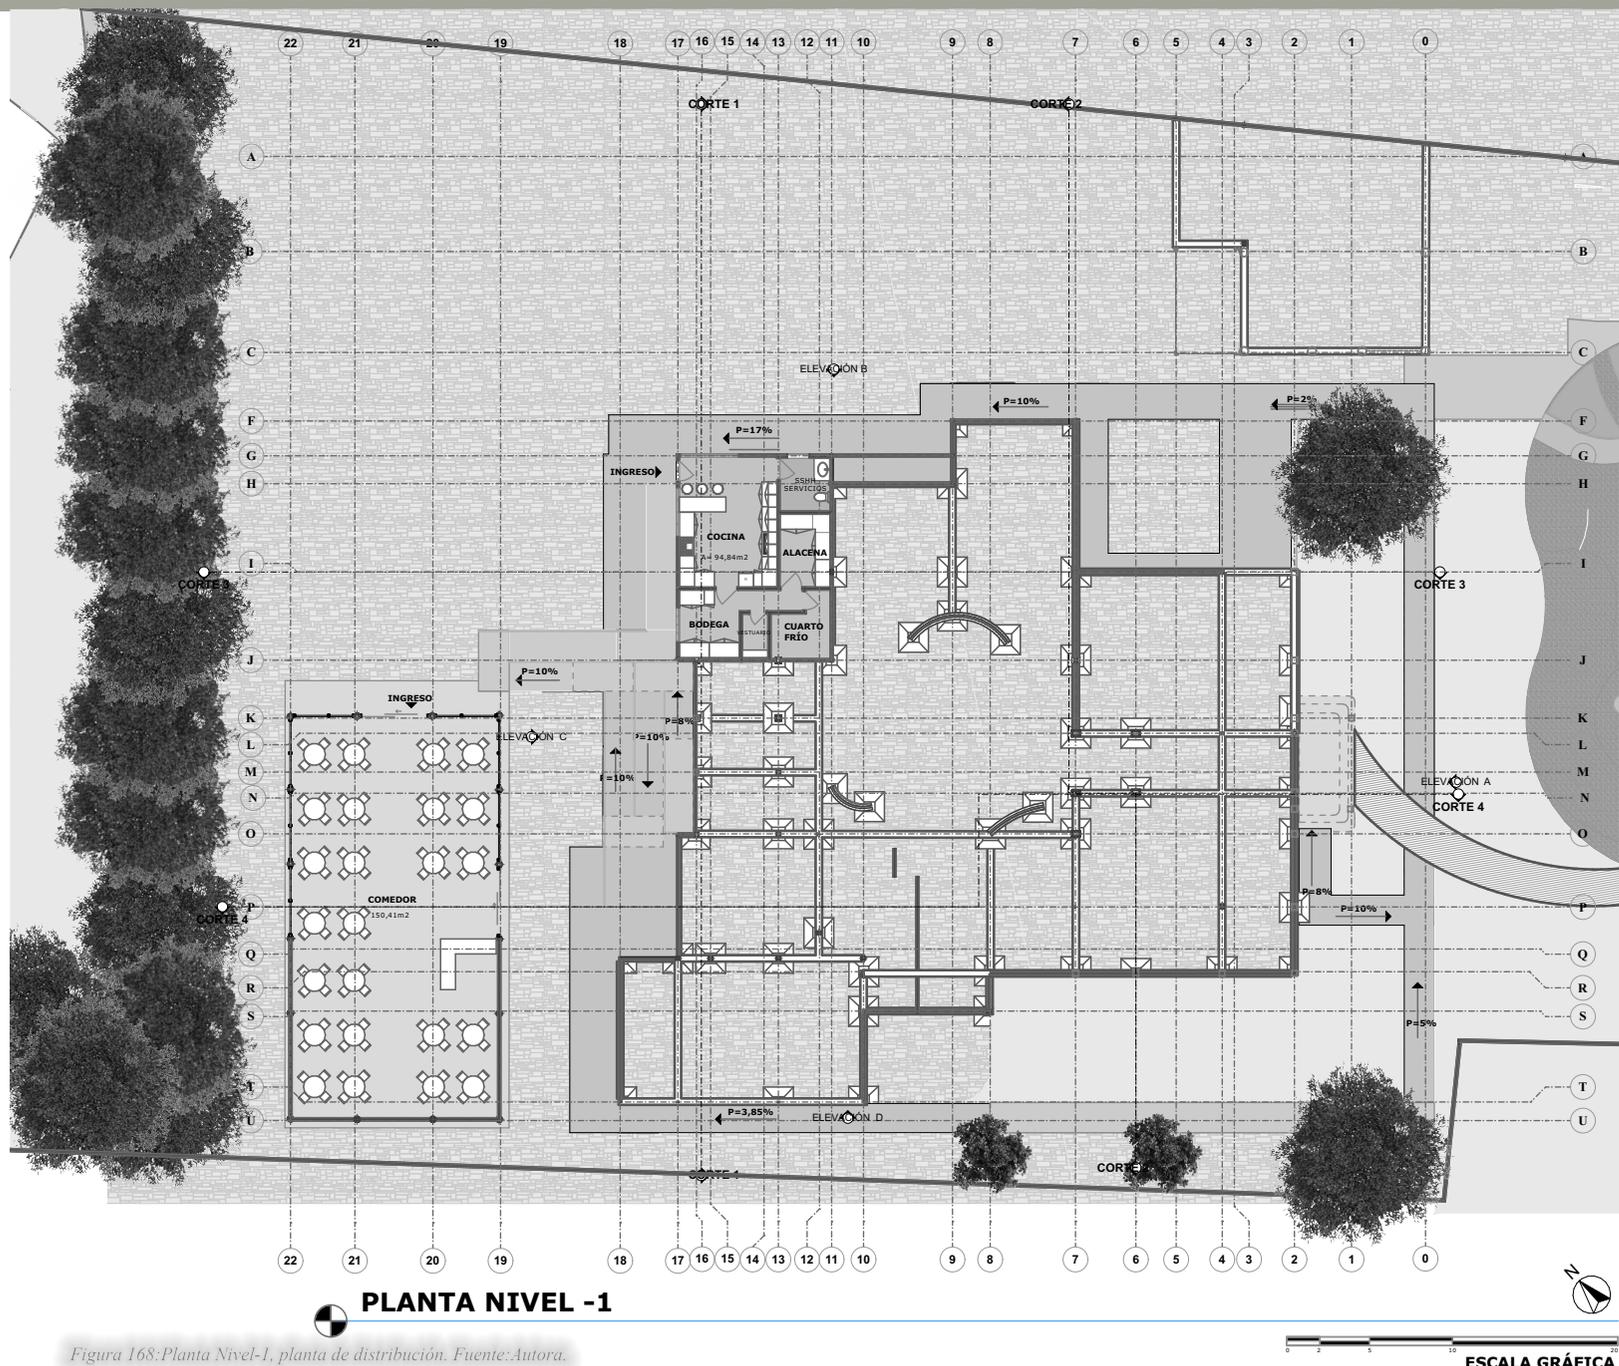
Planta Nivel-1, planta de distribución. Fuente: Autora.
